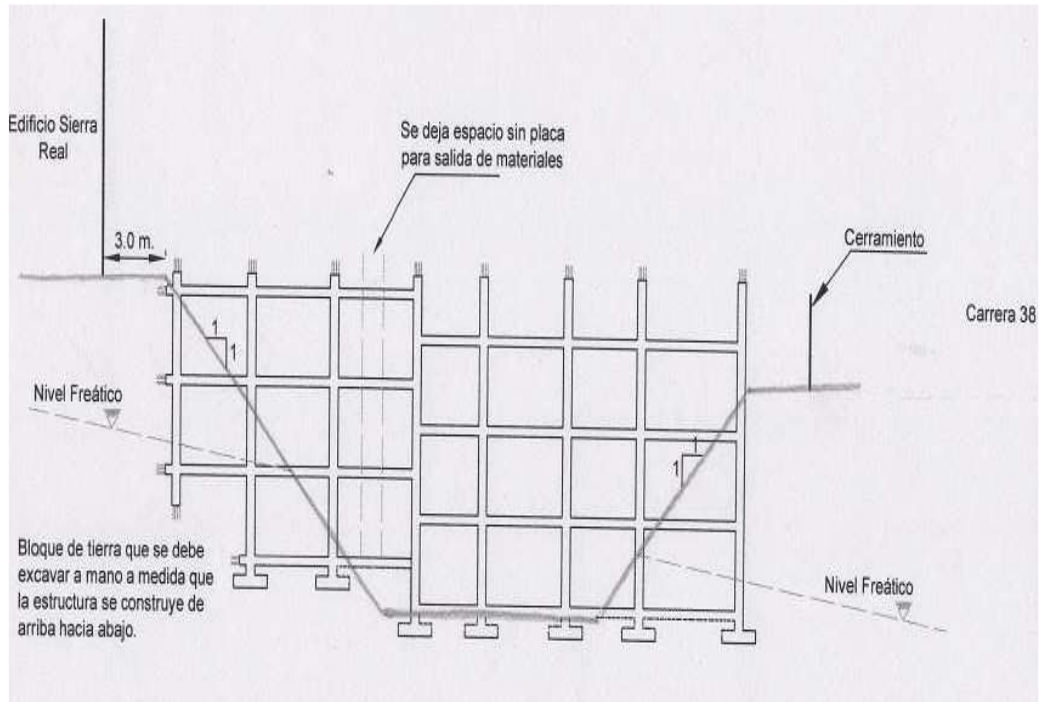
Diagrama 6 Construcción cimentación, Estudio geotécnico de suelo.
